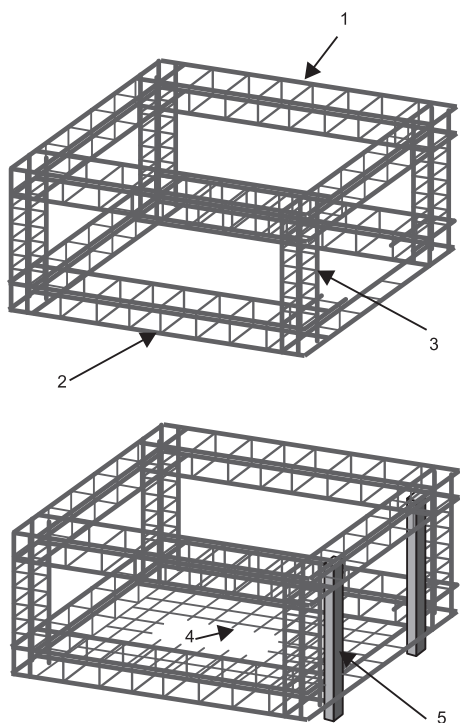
Скелет армирования: 1 — арматура сейсмопояса; 2 — арматура фундамента; 3 — арматура колонн; 4 — сетка под стяжку пола; 5 — стойки ворот
